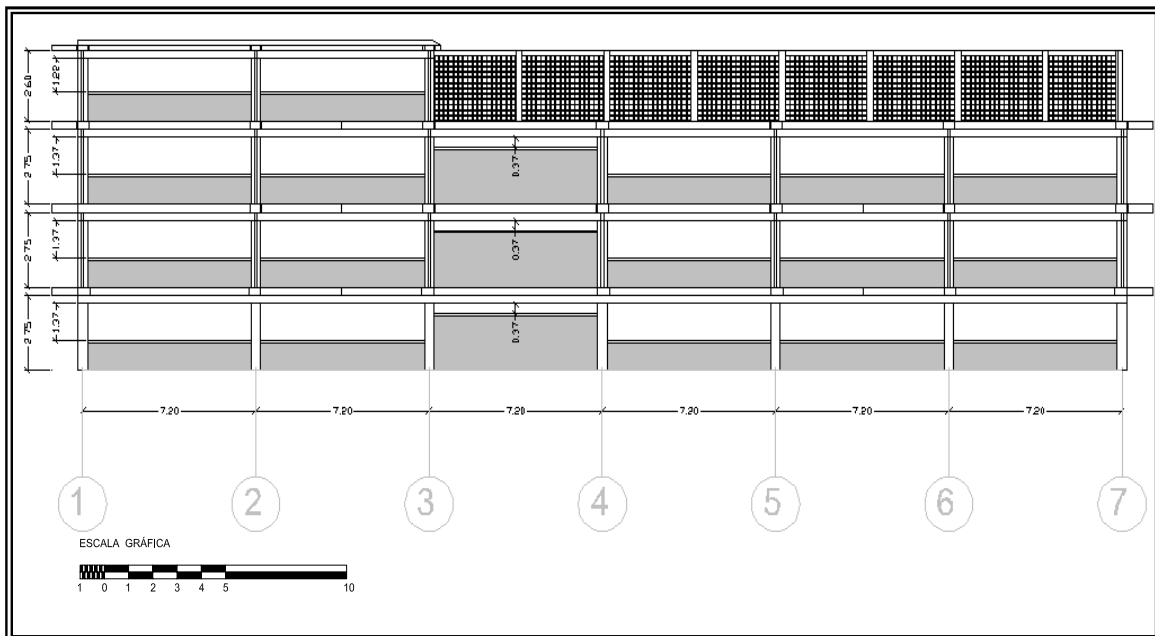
Pórtico F (este-oeste) mostrando las paredes de mampostería y la longitud efectiva de columnas
